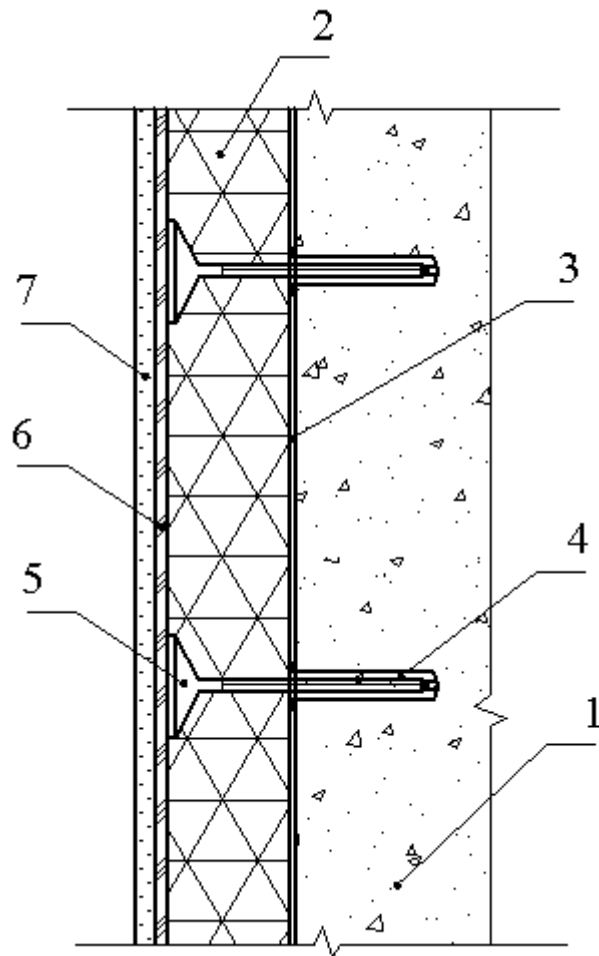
Схема наружной стены с эффективной теплоизоляцией с оштукатуриванием фасада
